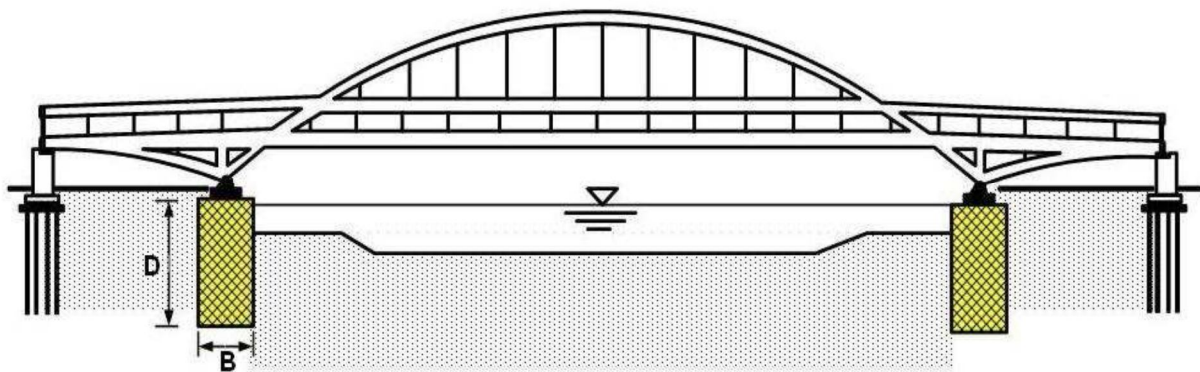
Utilisation de la fondation caisson dans les ponts: le pont de l'île Rokko à Kobe, Le Japon, un pont à deux étages à arc de longueur de 217 m construit en 1992
